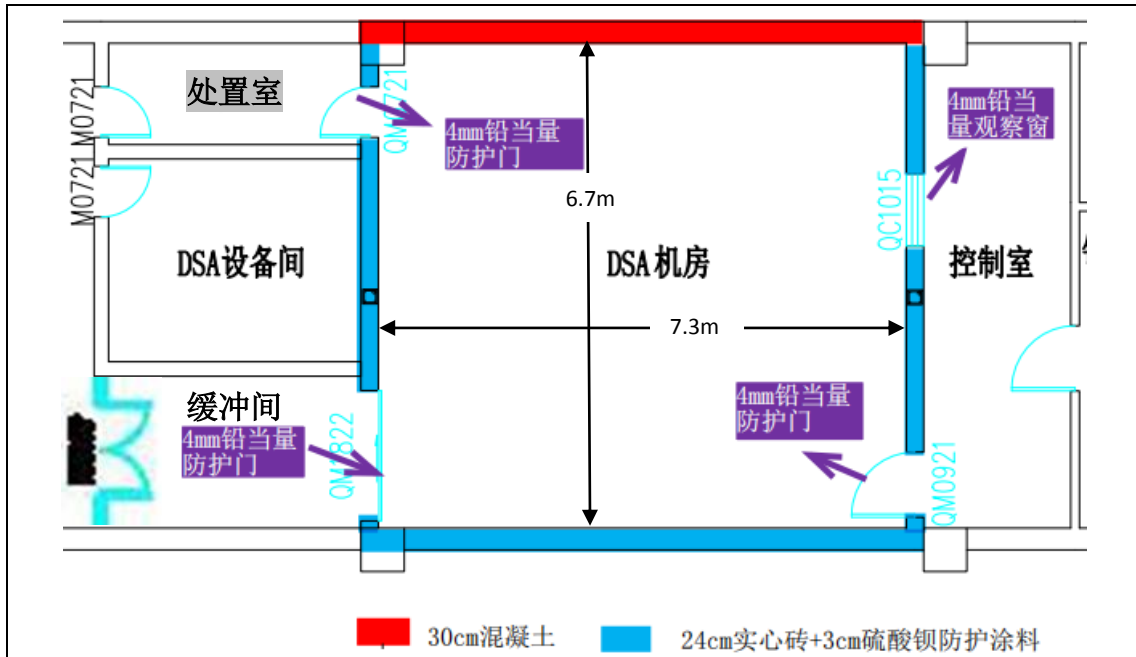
DSA 机房屏蔽结构示意图（平面）图
